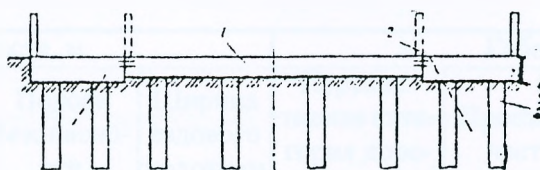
Схема уширения при уширении насыпи: 1 – существующая насадка; 2 – удаляемый открьлок; 3 – дополнительные сваи; 4 – сборные конструкции уширения.
